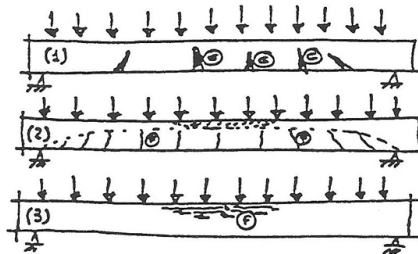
Localización probable de las grietas en función de la cuantía de armadura inferior para absorber el momento positivo. Arriba, grietas debidas a la baja cuantía de dicha armadura. En el centro, cuantía alta: se marcan grietas en la parte inferior y se insinúa el exceso de compresión en la zona central superior de la pieza. Abajo, cuantía muy alta: solo se forman grietas por exceso de compresión en la zona central superior de la viga.
